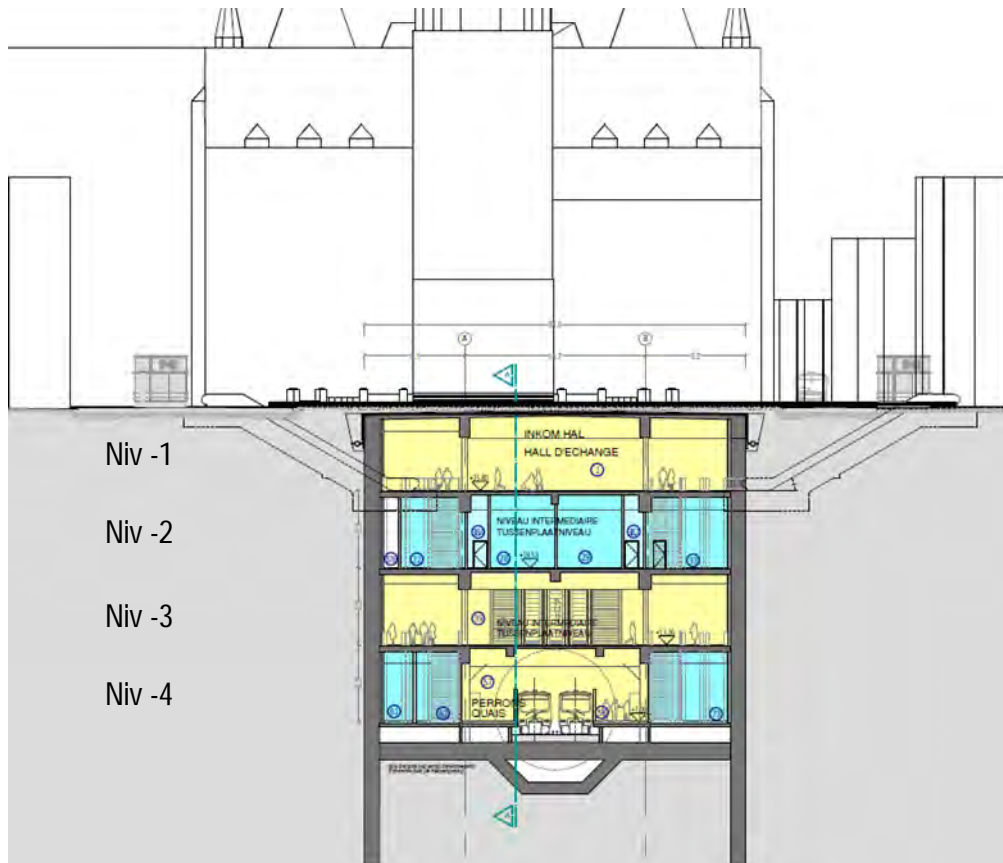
Coupe transversale de la station Colignon (BMN, 2018)
